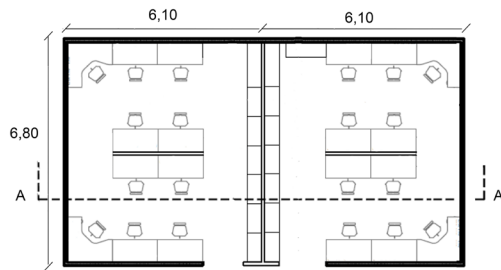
Planta tipo de dos oficinas de tipología arquitectónica abierta (OA). Medidas en metros. Fuente: Elaboración de las autoras.
